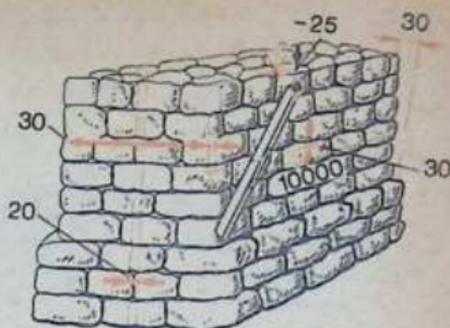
Допускаемые отклонения при кладке фундаментов из бутового камня (пунктирными линиями обозначены границы допускаемых отклонений)
